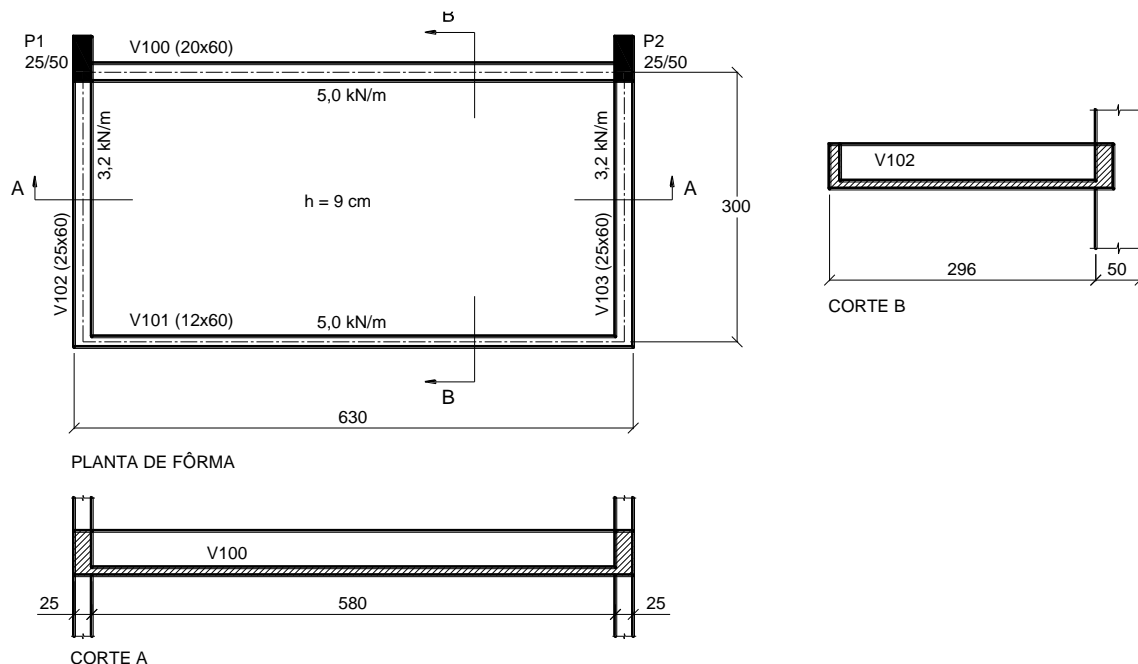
Planta de fôrma e cortes A e B (medidas em cm).
